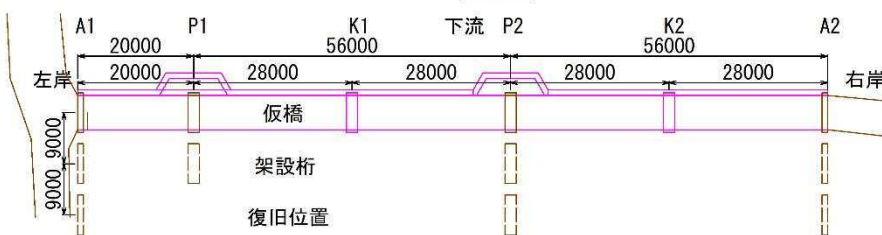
流失した橋梁と復旧する橋梁の側面図, 平面位置図
